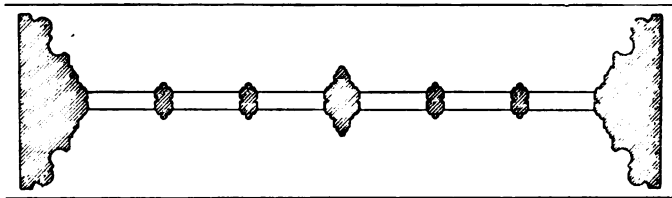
Gent. Jesuitenkirche. Profil des Mittelfensters der Fassade.
